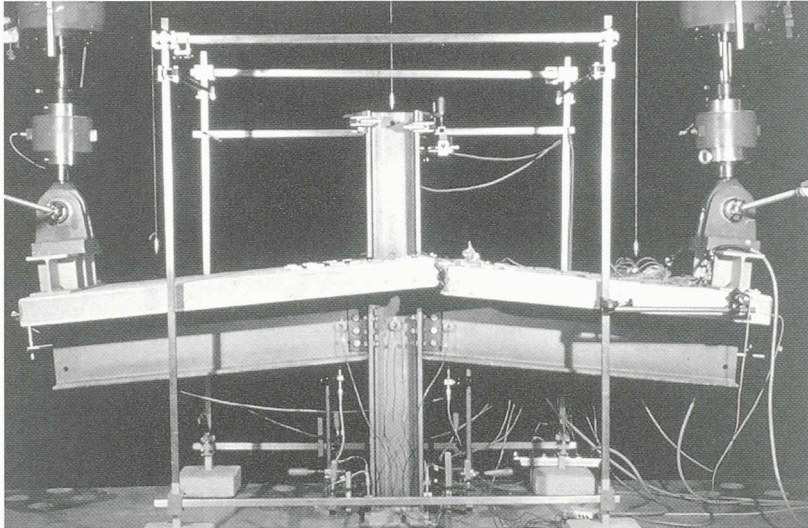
Essai de rupture en laboratoire d'un nœud mixte semi-rigide constitué d'un assemblage par double cornière et d'une dalle en béton faiblement armé
